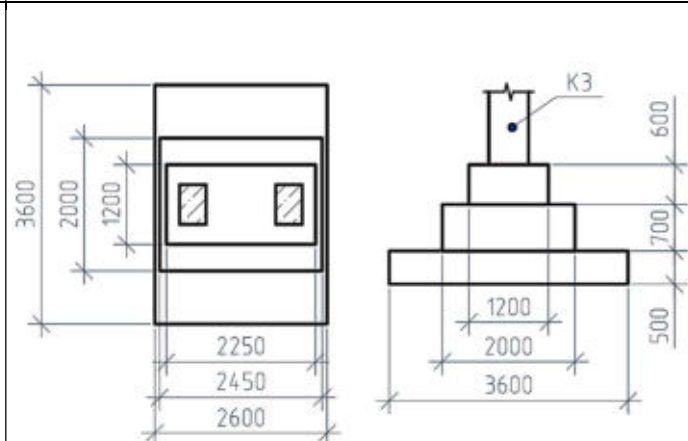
Общий вид конструкции фундамента в/о 18-19/В
